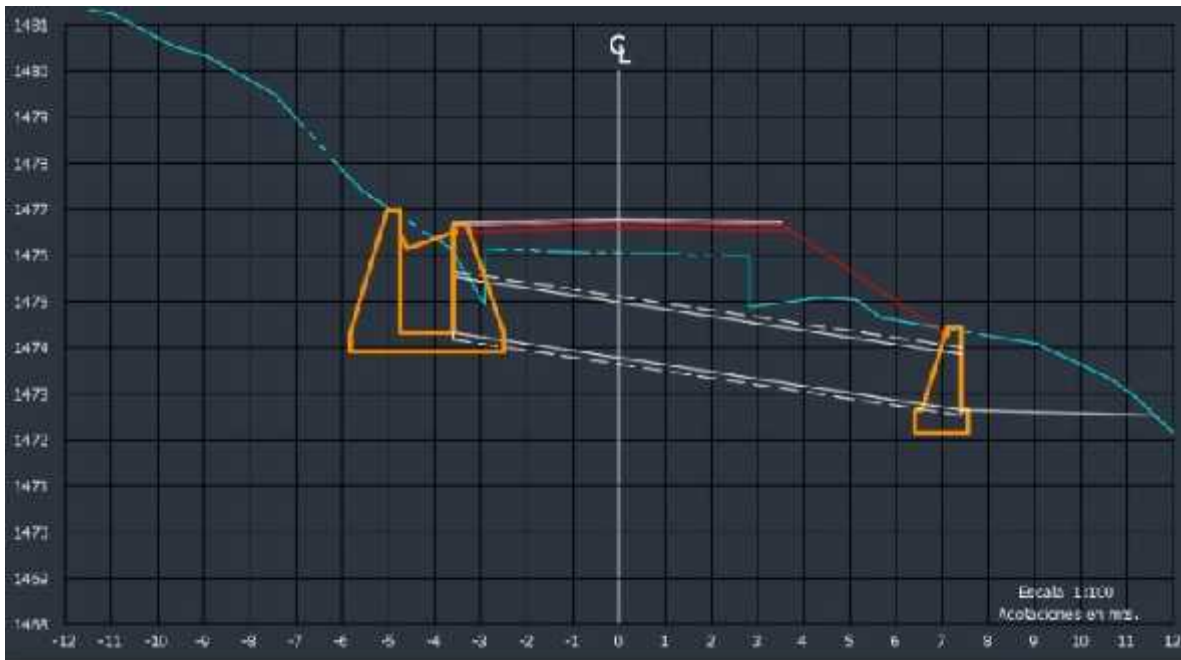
Ejemplo obra de drenaje Km 3+695.61.
